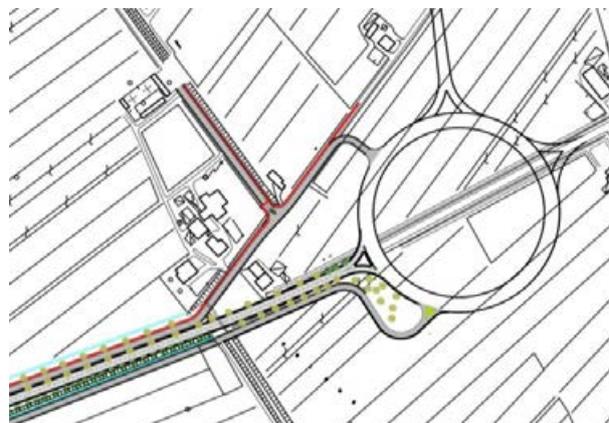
PLANIMETRIA COMPLESSIVA DELL'INTERVENTO
